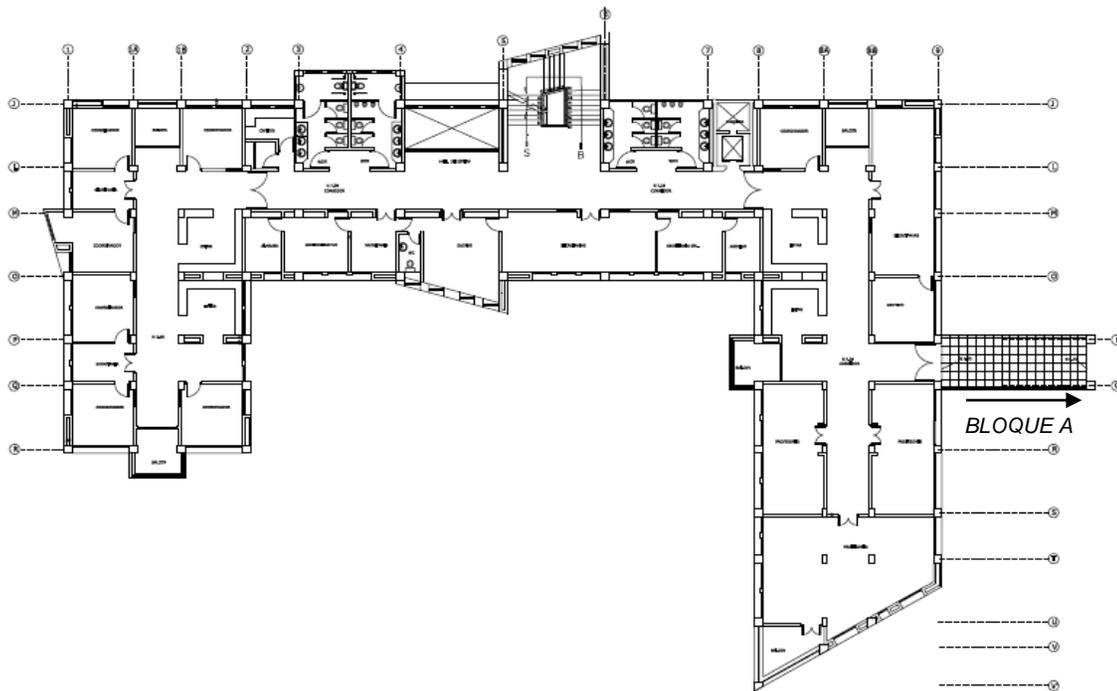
Distribución arquitectónica Vista en planta Bloque Administración
